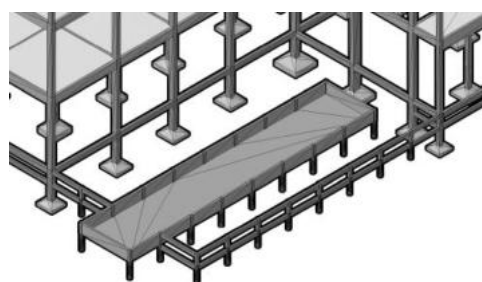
Estrutura aos fundos da edificação, (Mini Lago Ornamental) projetada com paredes estruturadas em concreto armado, fundações executado com estacas em profundidade mínima de 1,20m.
